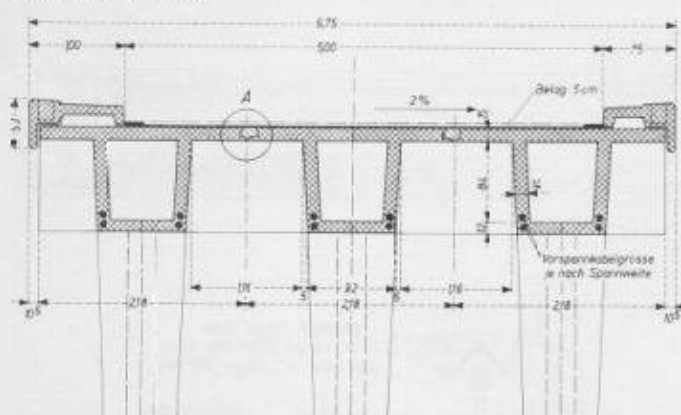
Voll vorfabrizierte Ueberführung, Querschnitt 1:80. Detail A: Fuge (Asymmetrie wegen Montage)
